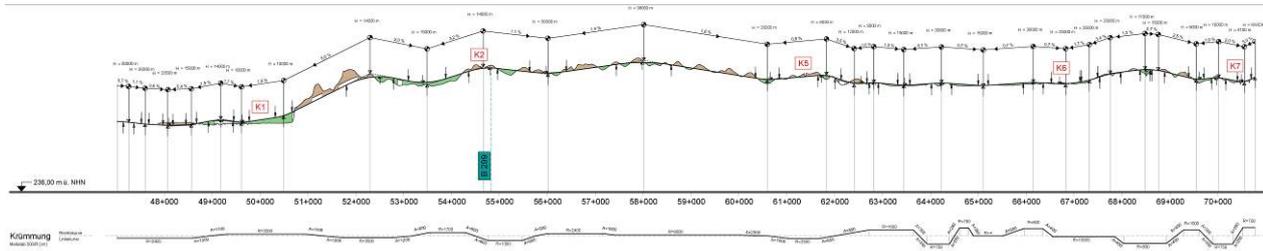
Höhenplan Planfall 1c (Unterlage 4, Blatt 3)
